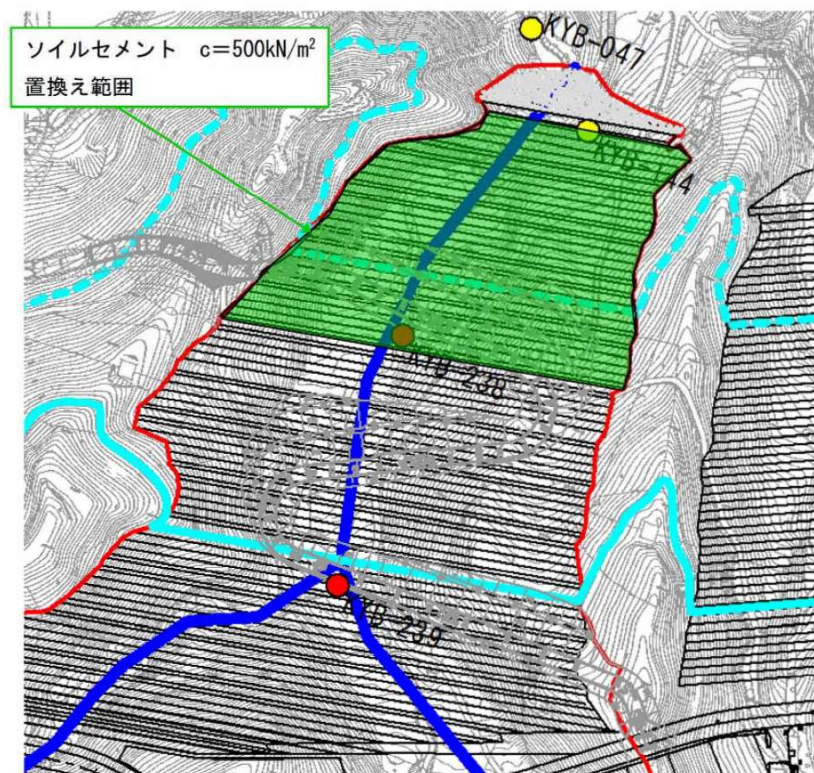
川原湯地区①ソイルセメント置換え 平面図
